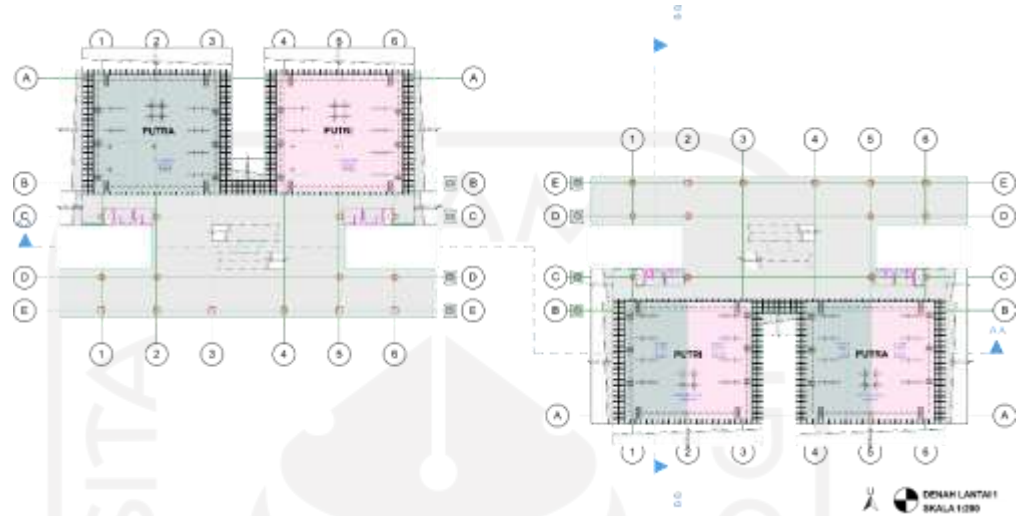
Denah Modul Bangunan Siswa Ruang Tidur
